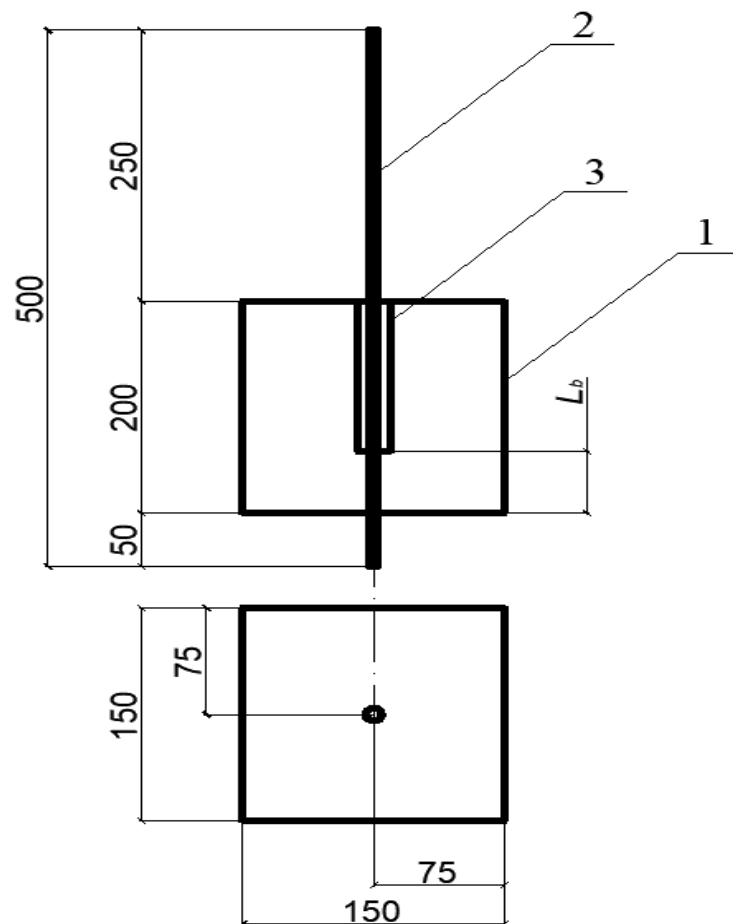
Схема призмового зразка: 1 – бетонна призма; 2 – арматура; 3 – полімерний ущільнювач
